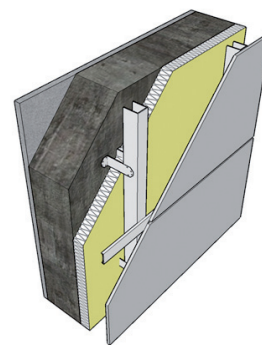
Solución Muro N° 3 Muro de hormigón armado de e : 200 mm. con estuco interior de e : 25 mm y sistema de fachada ventilada, con aislante térmico de lana de vidrio en rollo, en diferentes espesores, cámara de aire ventilada y revestimiento exterior en panel de fibrocemento.
